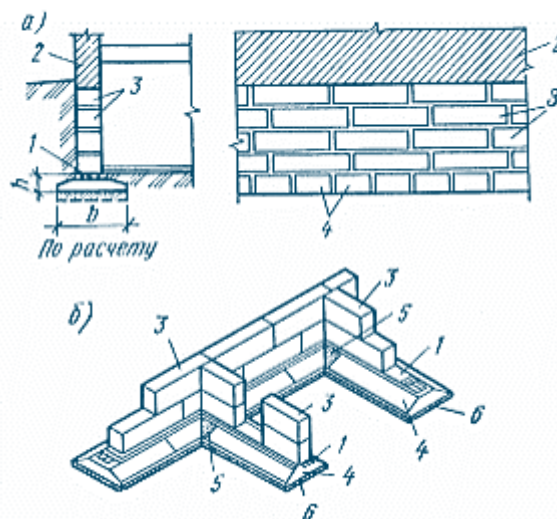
Стрічковий збірний фундамент із великих блоків: а – розріз і фрагмент розкладки конструкції фундаменту; б – загальний вигляд; 1 – армований пояс; 2 – стіна; 3 – фундаментний блок; 4 – блок подушка; 5 – ділянка що бетонується на місці; 6 – підготовка підготовки
